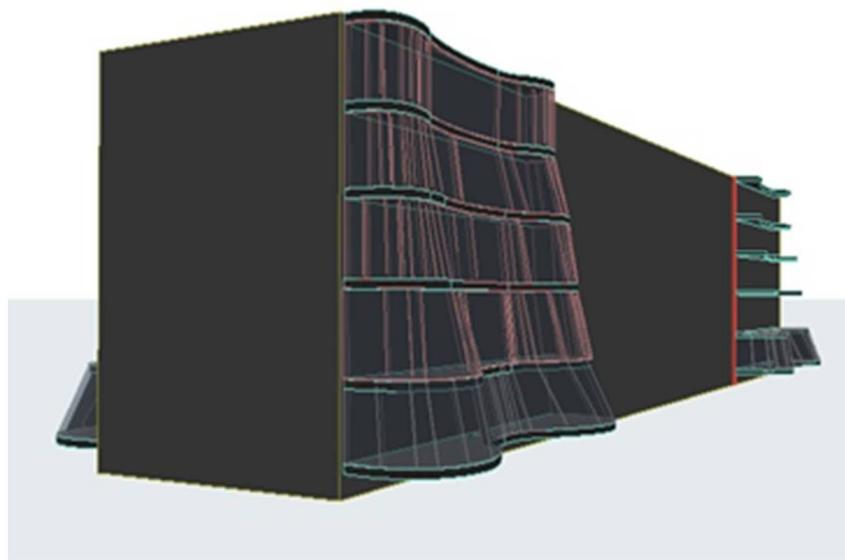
Пример решения фасада 5-ти этажного жилого дома
